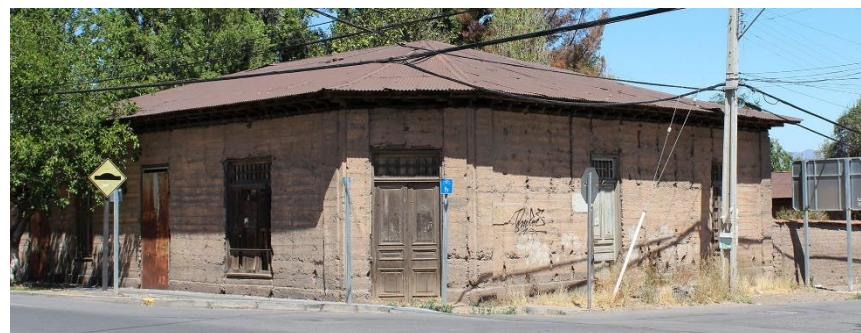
Vivienda construida en tierra en San Esteban. Fuente: Elaboración propia.
